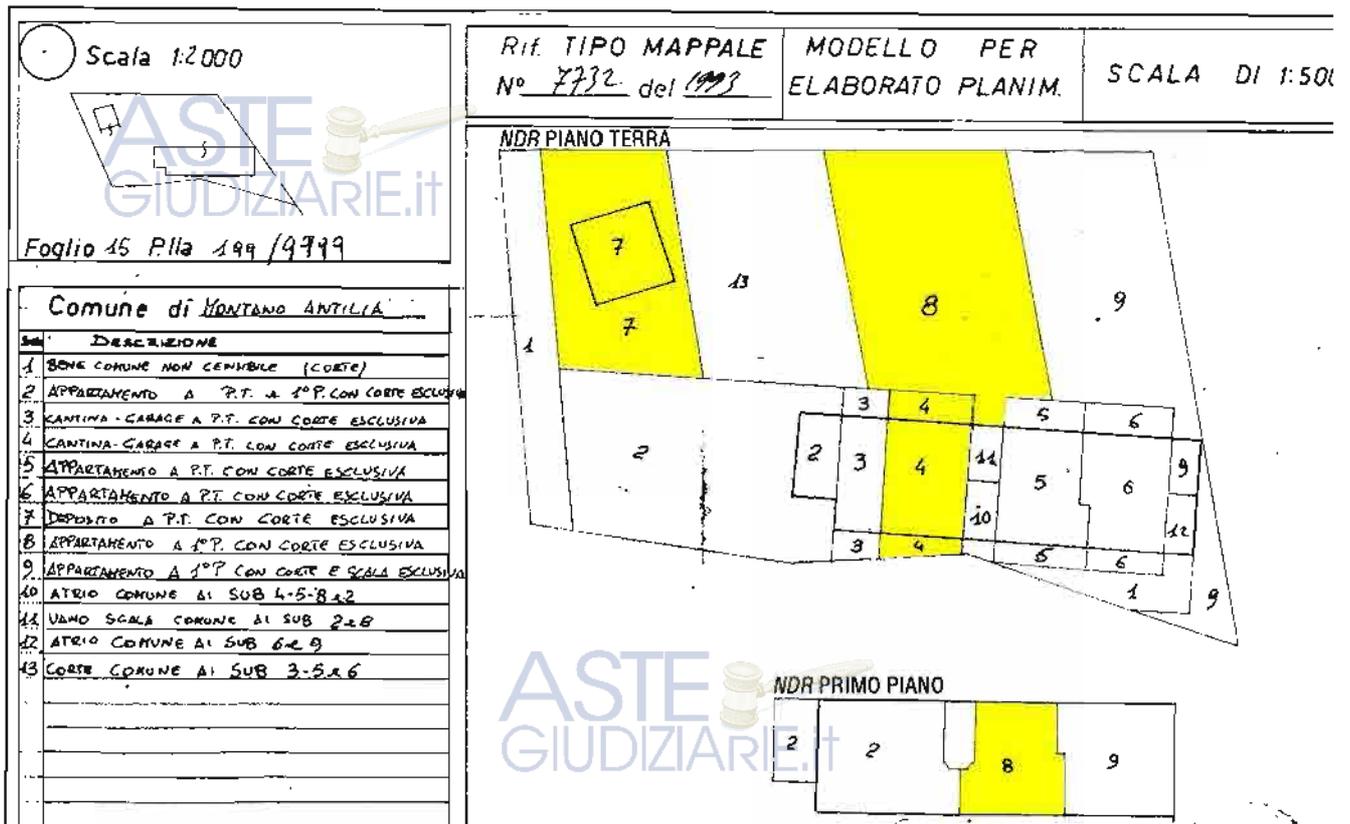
Stralcio elaborato planimetrico Montano Antilia - Fig. 15 part. 199
